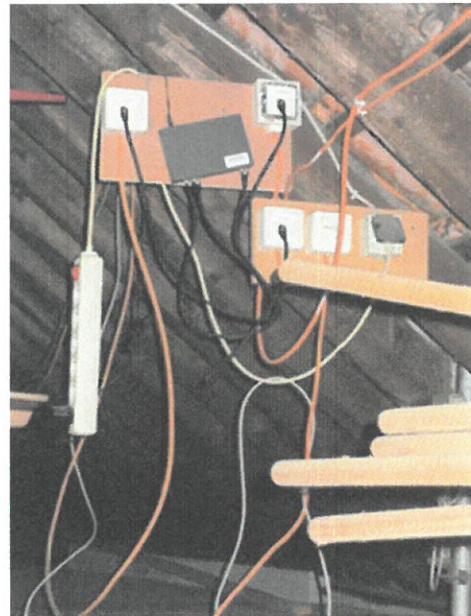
, „fliegende Verkabelung“ Dachboden Altbau
